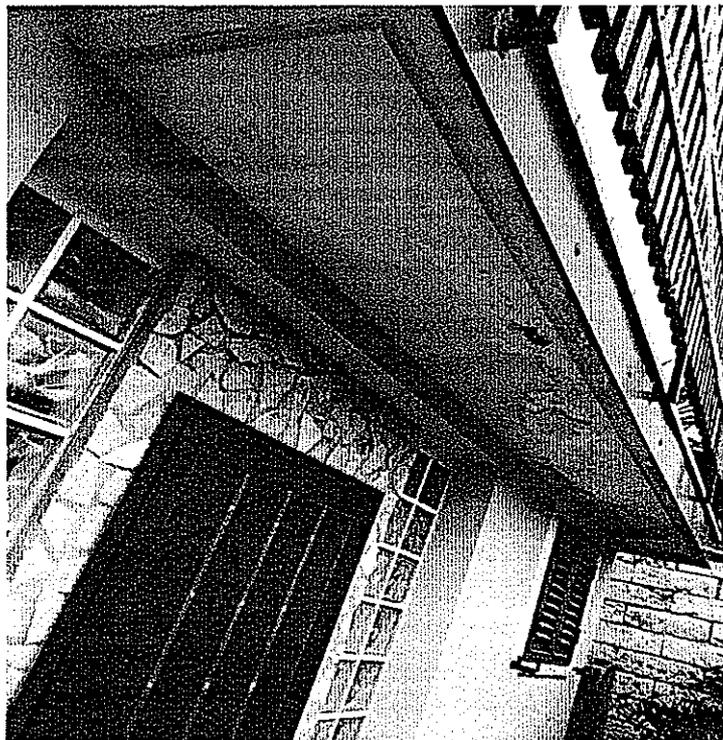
Screpolature balconi e vista ingresso cucina piano seminterrato
